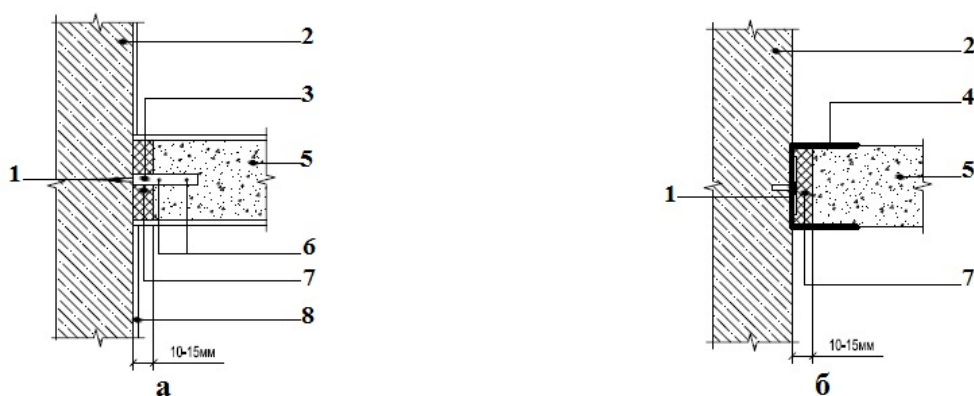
Узлы примыкания внутренних стен к несущей стене или железобетонной колонне: а — крепление с помощью полосового анкера; б — крепление с помощью стального профиля: 1 — дюбель; 2 — несущая стена или железобетонная колонна; 3 — полосовой анкер; 4 — стальной профиль; 5 — внутренняя стена (перегородка из блоков); 6 — винты-саморезы; 7 — уплотнитель (минеральная вата, пенополистирол, монтажная пена; 8 — внутренняя отделка
